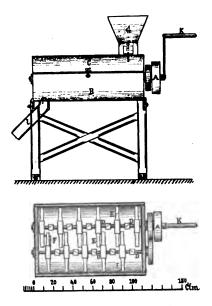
Grundriss. Mörtelmaschine.
